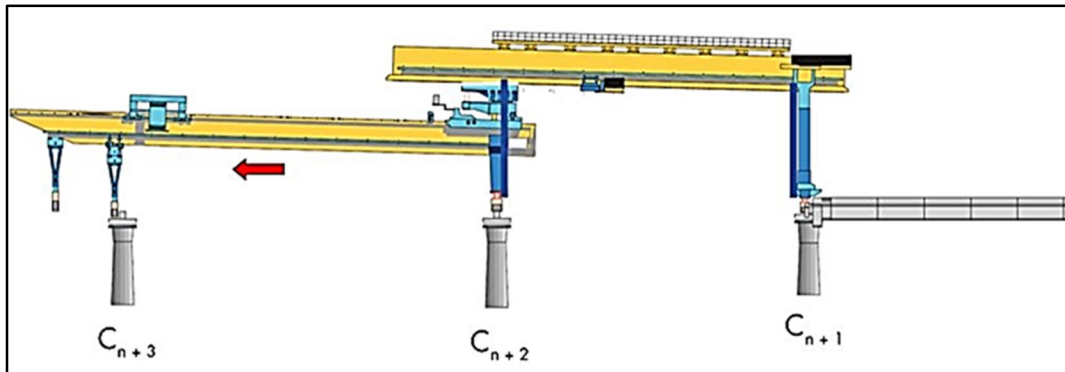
Fase 3: avance de la viga inferior. Viga lanzadora lista para nuevo vano
